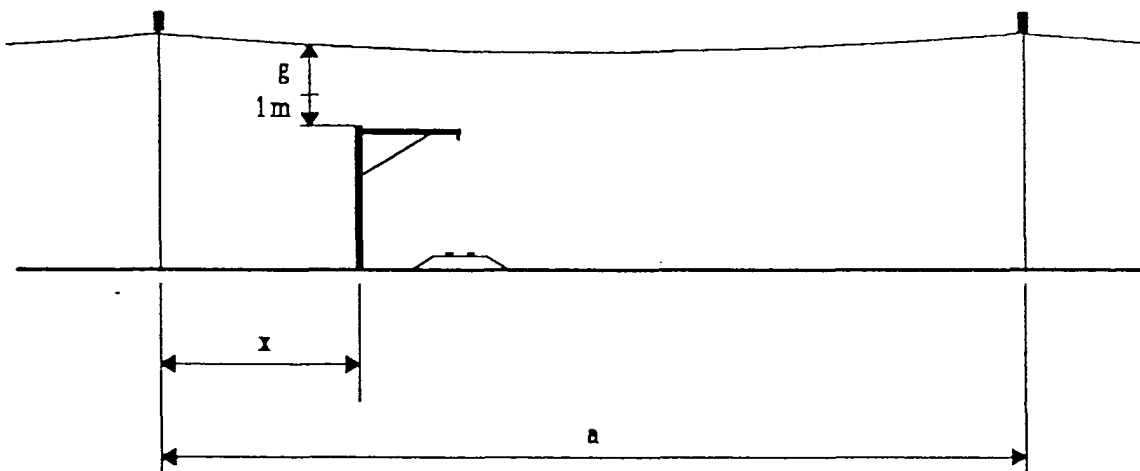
$a > 300$ m traversée au droit d'un support de caténaire
